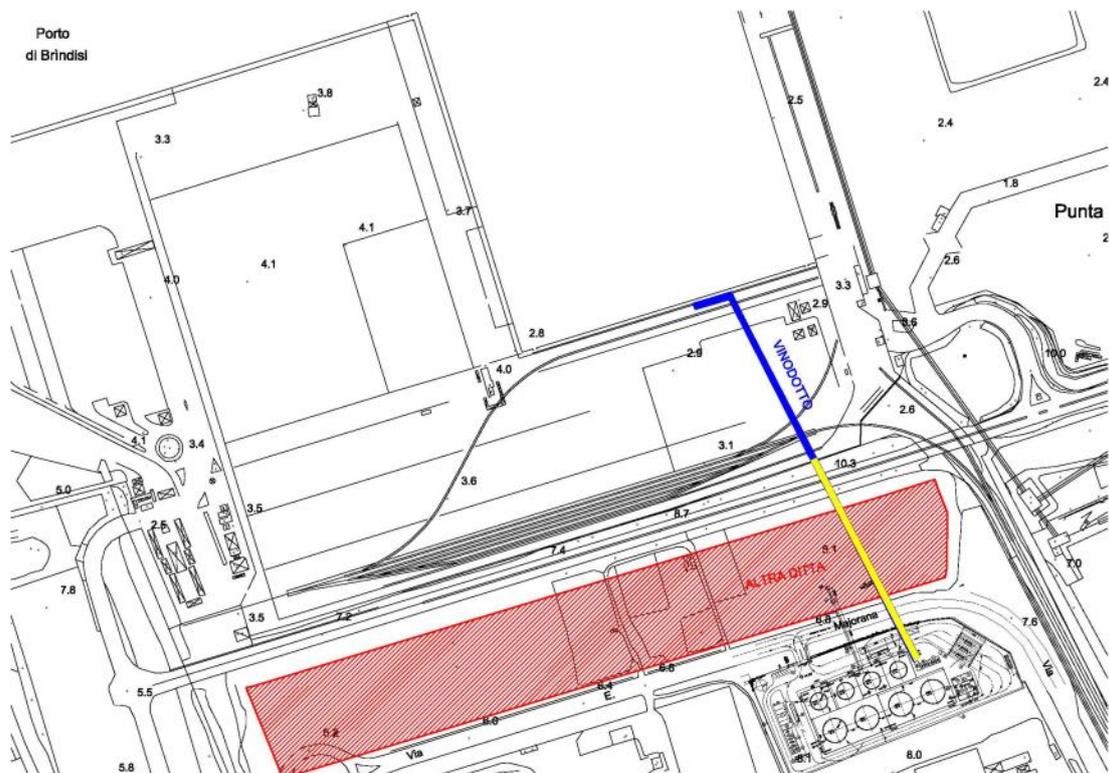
STRALCIO PLANIMETRICO CONDOTTA ESISTENTE (IN BLU LA CONDOTTA IN AREA D.M.)
